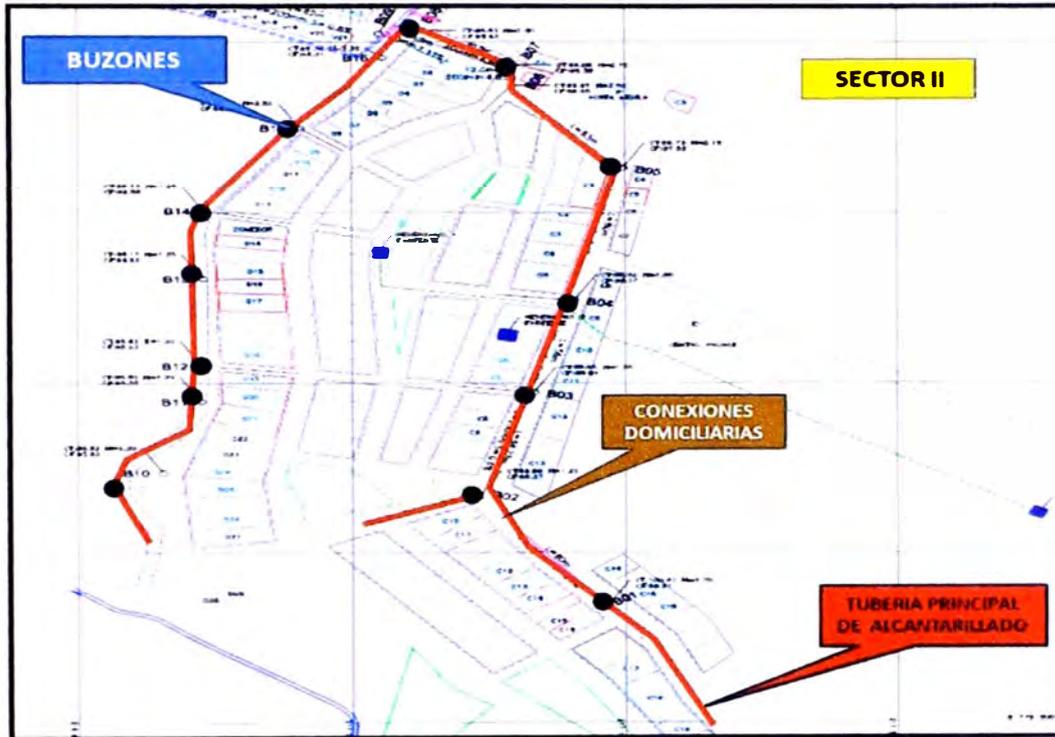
Sector II: Sistema de Alcantarillado-I .
